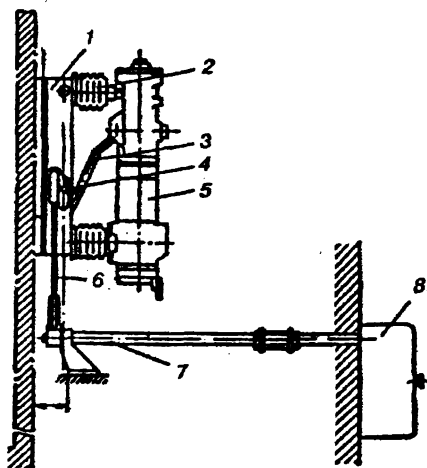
Внешний вид выключателя с приводом типа ПЭ-11
